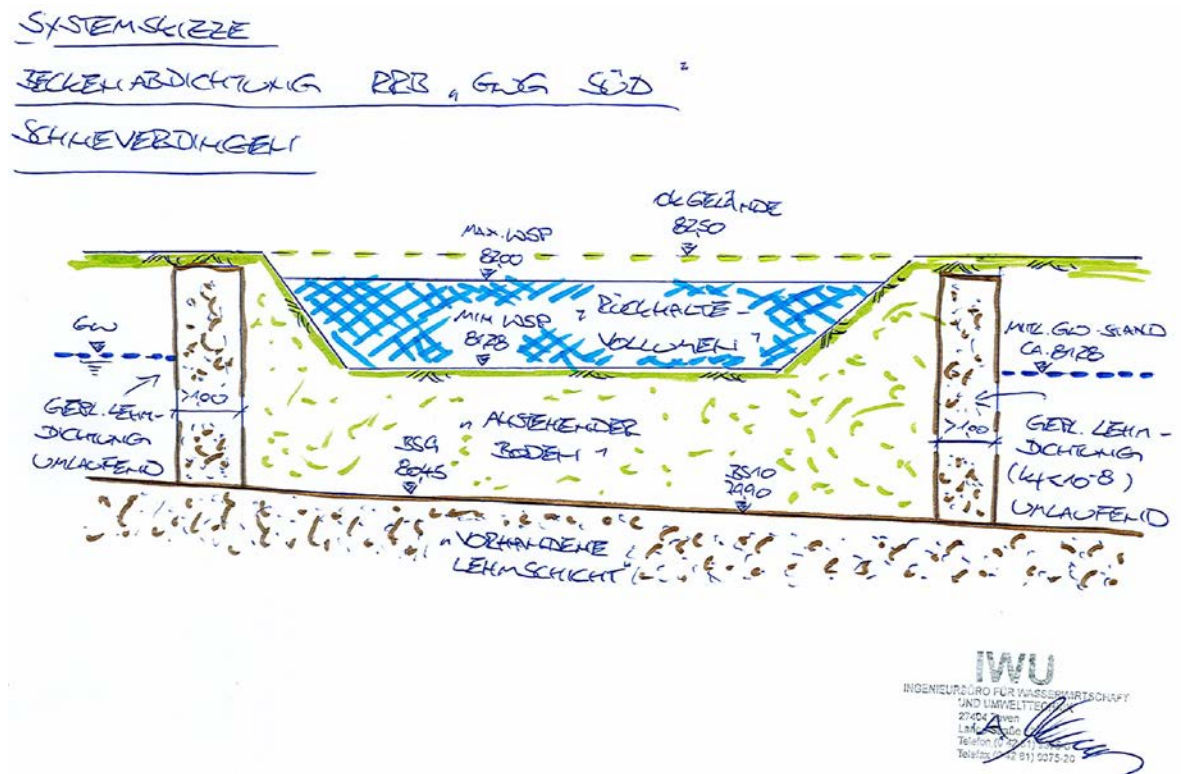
Systemskizze Abdichtung Regenwasserrückhaltebecken
